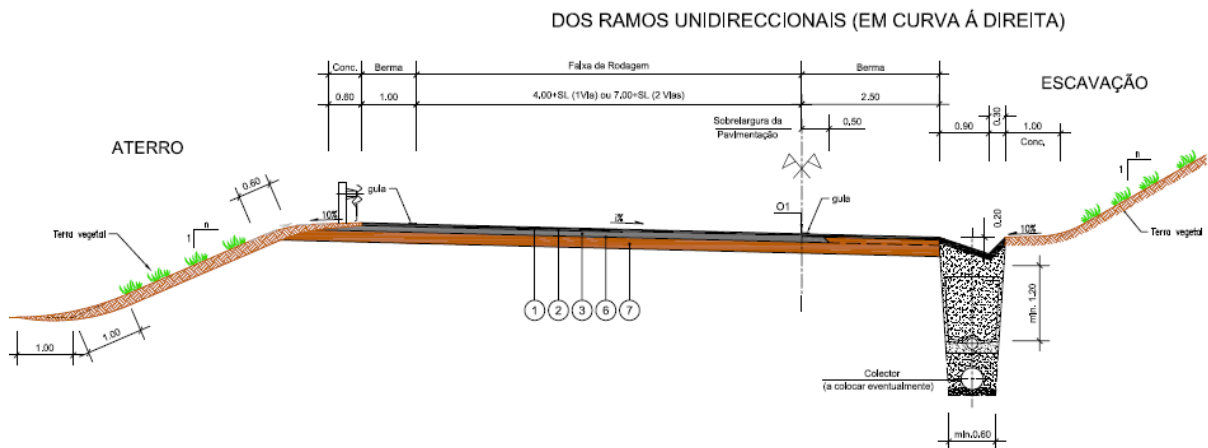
Perfil Transversal Tipo dos Ramos de Ligação
